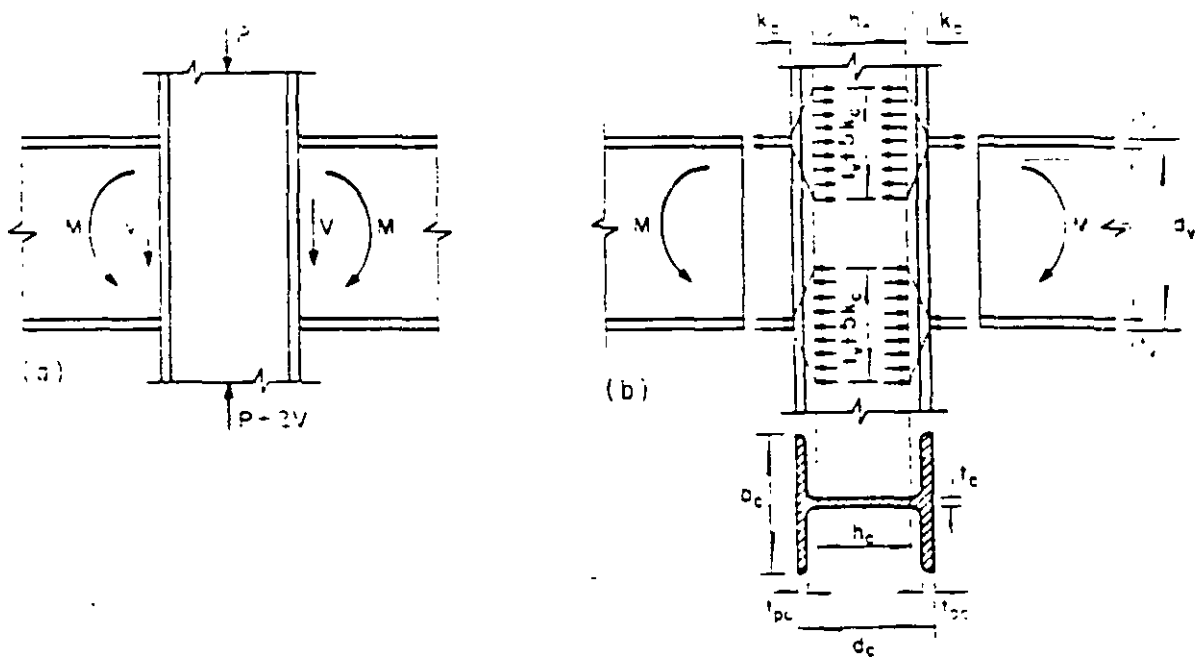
Conexión viga-columna con carga vertical simétrica.
